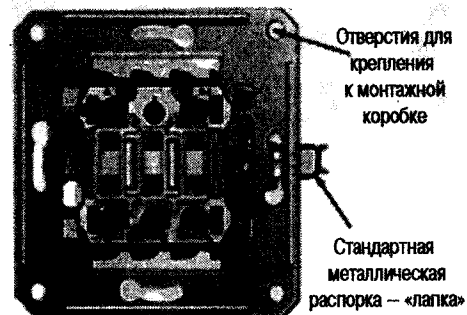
Металлическая пластина с отверстиями под шурупы и крепежными распорками для установки выключателя
